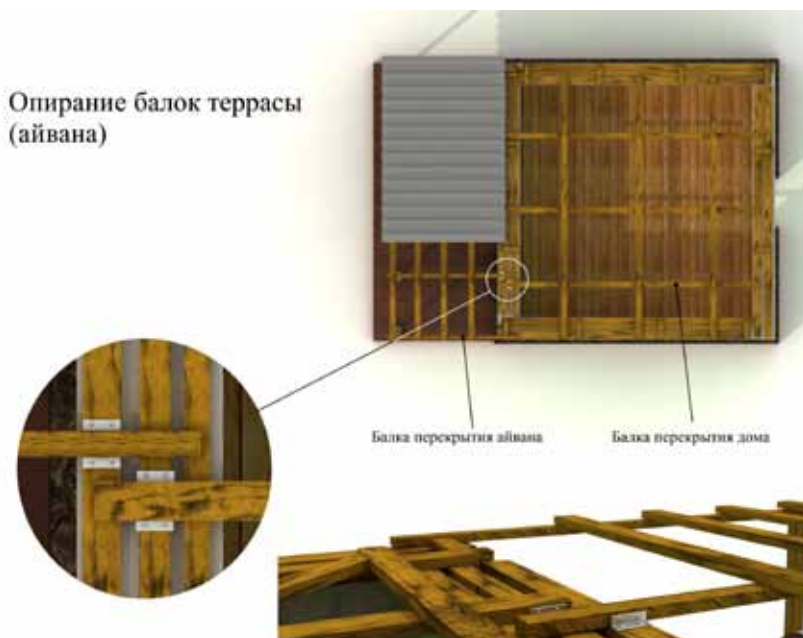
Опираание балок перекрытия веранды (айвана) к элементам перекрытия дома
